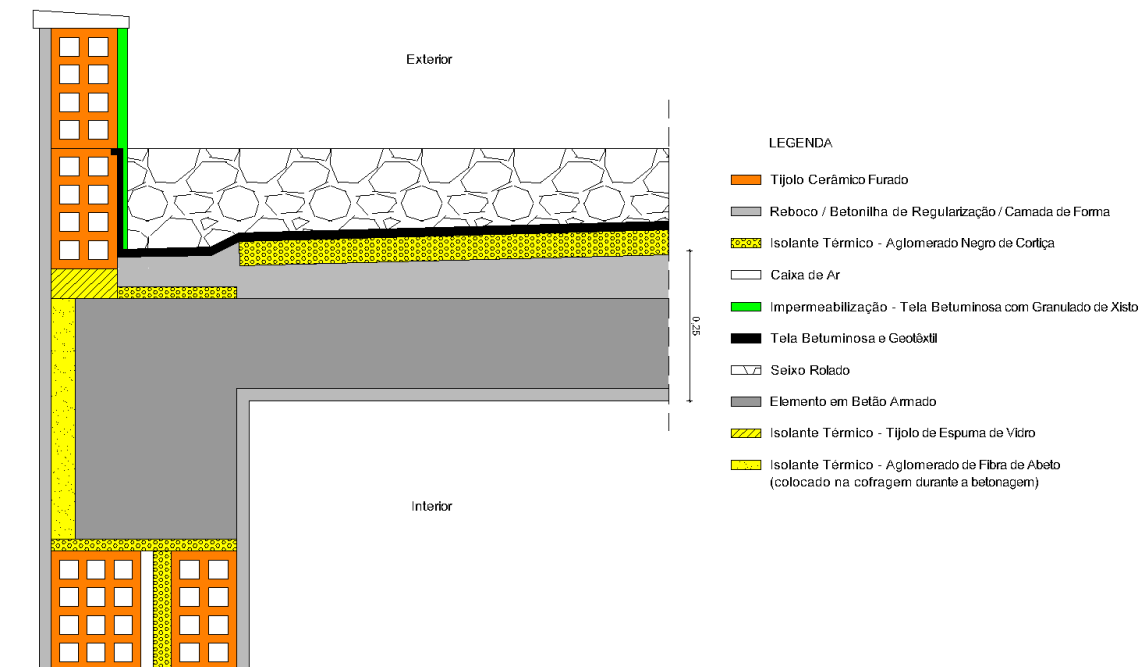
Ligação da fachada com cobertura plana não visitável, adaptado de [10]
